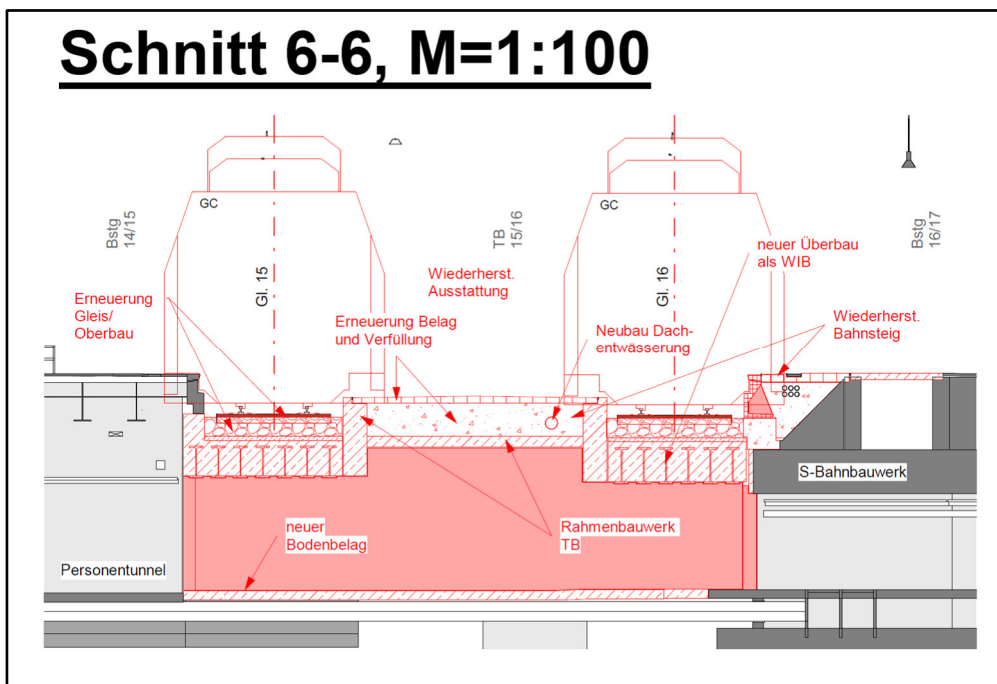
Bauwerksplan Tiefbahnsteig, Schnitt 6-6 aus [U2]
